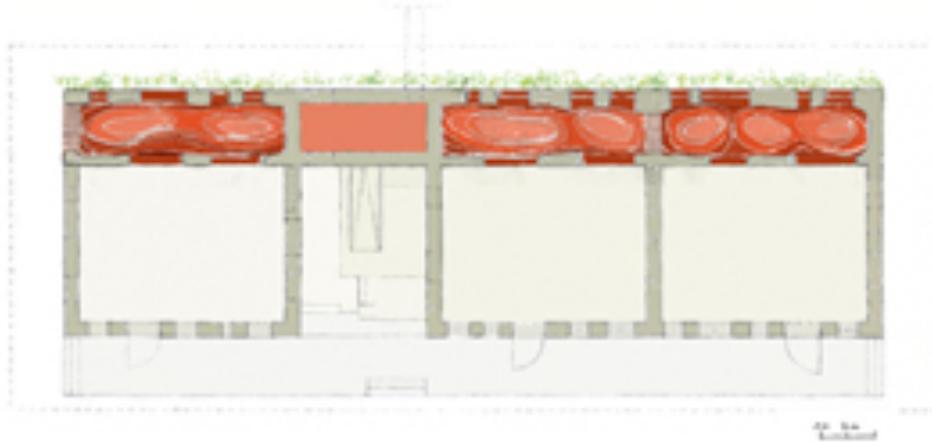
Boceto de la planta baja hecho por la autora. (Fuente: www.annaheringer.com)
